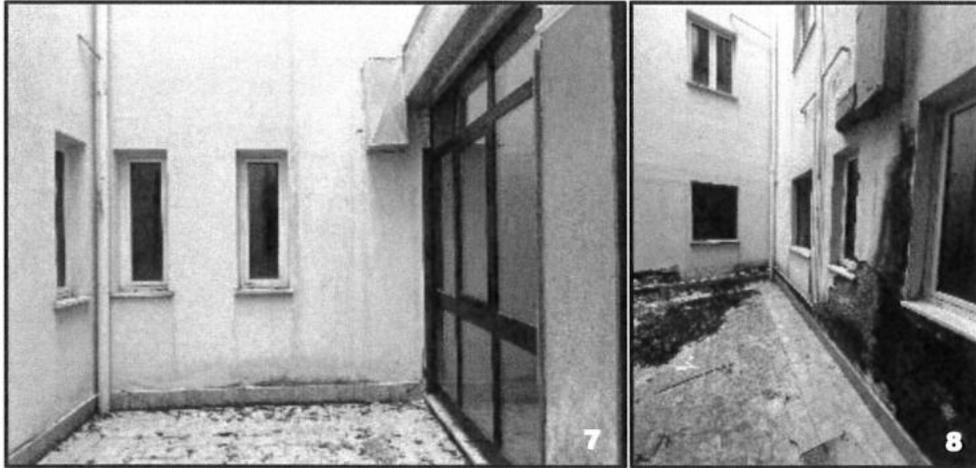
e 8 - Vista parziale prospetti dal cortile interno e dettaglio degrado parete
